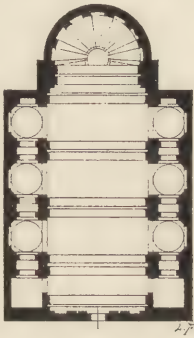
St. Lucia zu Bologna. Grundriss.
